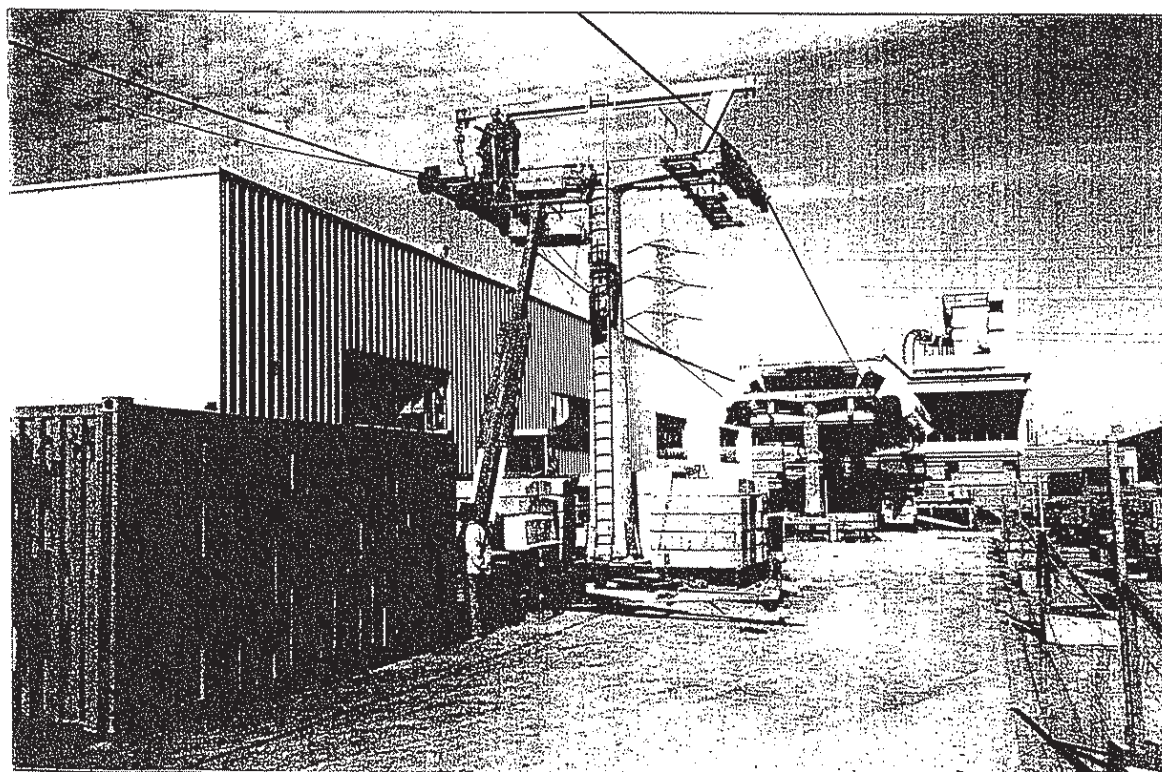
Sostegno in prova attrezzato con ponteggio fisso a terra, per sensore spostamento trasversa
